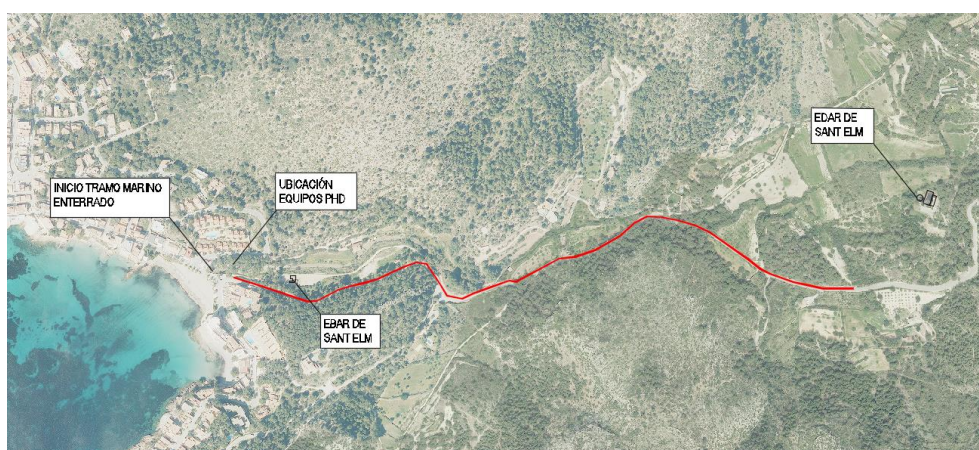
Tramo terrestre ocupado por tubería submarina.
